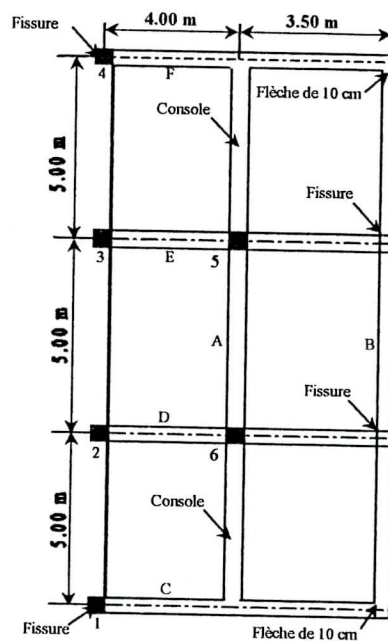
Vue en plan de l'auvent d'une station de service [1]
